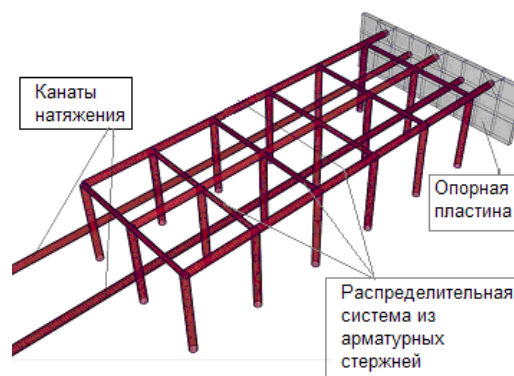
Общий вид верхнего узла усиления из расчетной схемы
